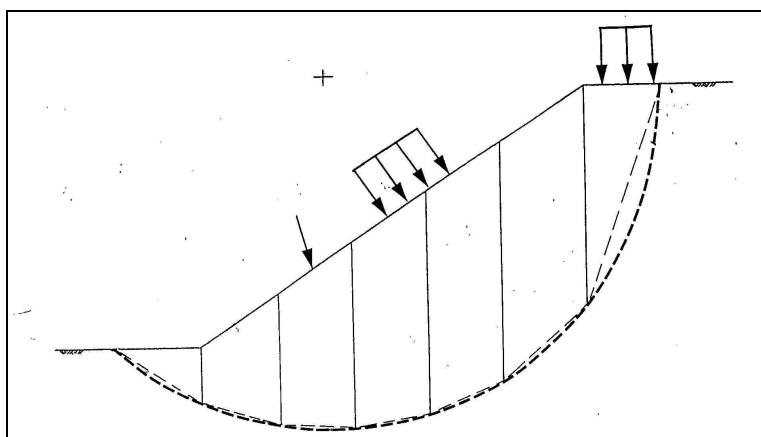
Blocco di terreno instabile: suddivisione in conci
